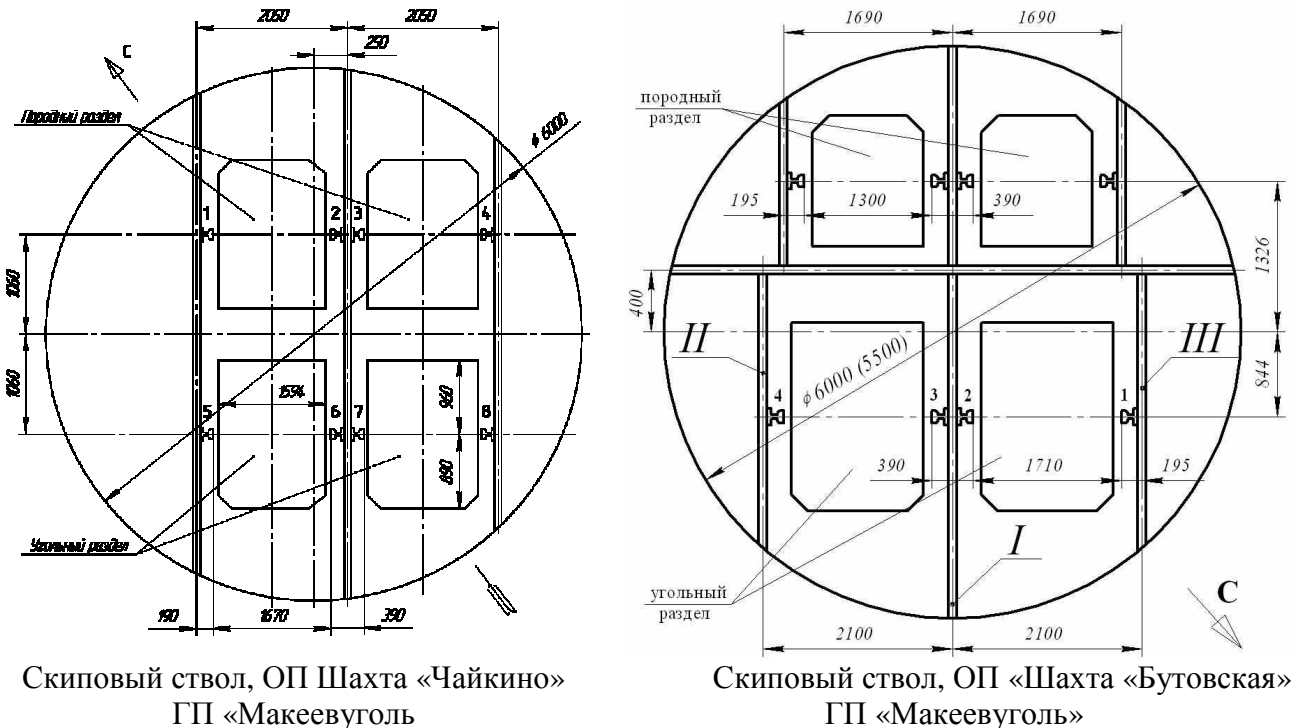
Схемы расчета армировки с жесткими проводниками
